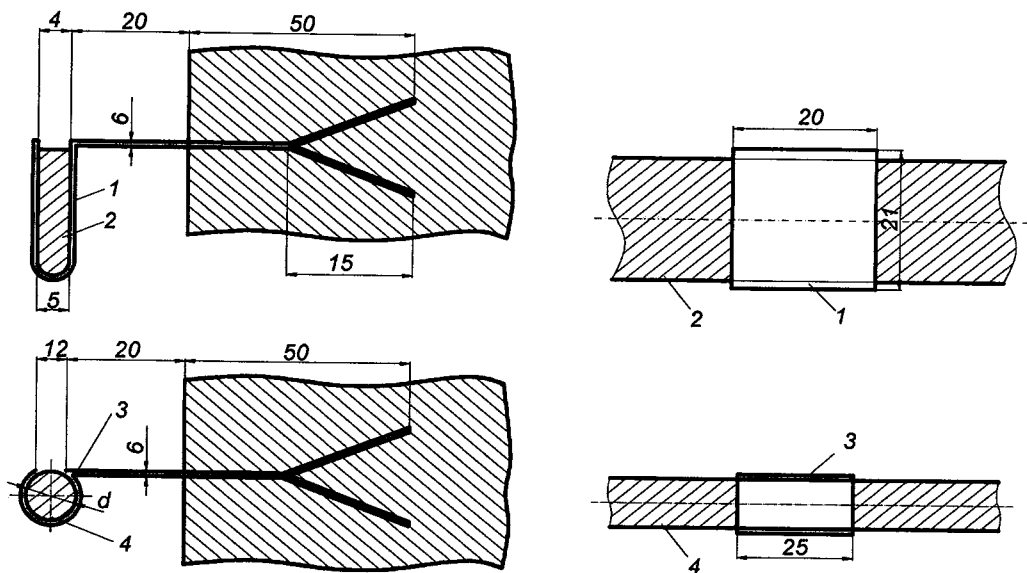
Схема крепления заземляющих проводников в камере с бетонной крепью: 1 – штырь для крепления плоских шин; 2 – шина; 3 – штырь для крепления троса; 4 – трос
